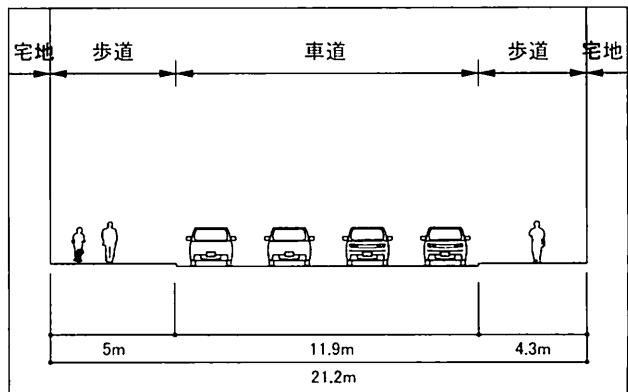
現在の国体道路の断面図（道路台帳平面図を基に筆者作成）
